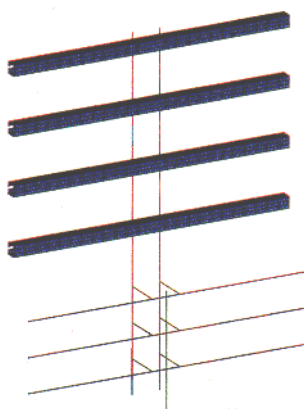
Motif BN4 avec poteaux en éléments poutres
